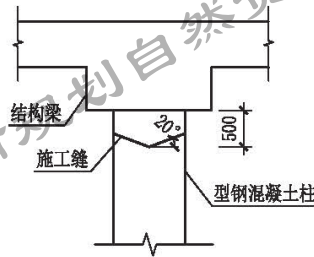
型钢混凝土柱逆作施工缝节点示意
